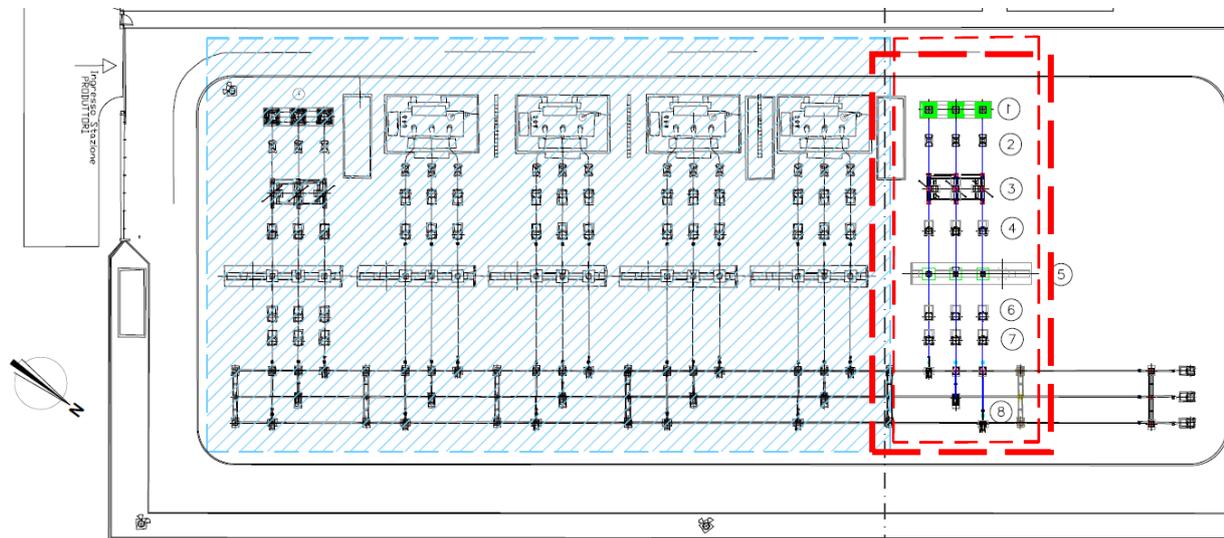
\_layout stazione elettrica Terna – stallo condiviso
